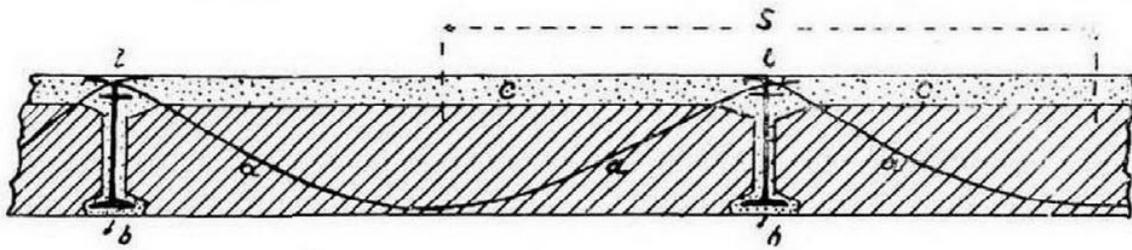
Estructura en donde se aprecian las vigas "T" y las varillas de hierro amarradas continuamente. La estructura posteriormente recibía una masa de concreto armado.
